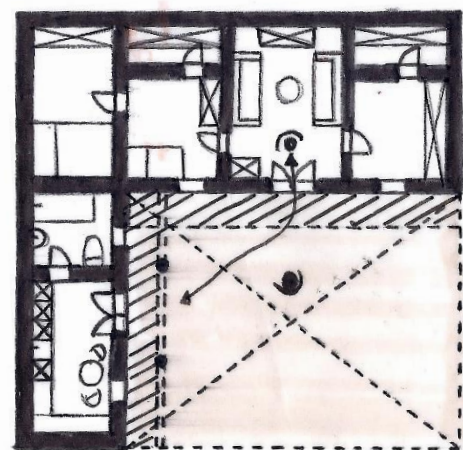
Croquis plan logement « M2 » rez-de-chaussée
